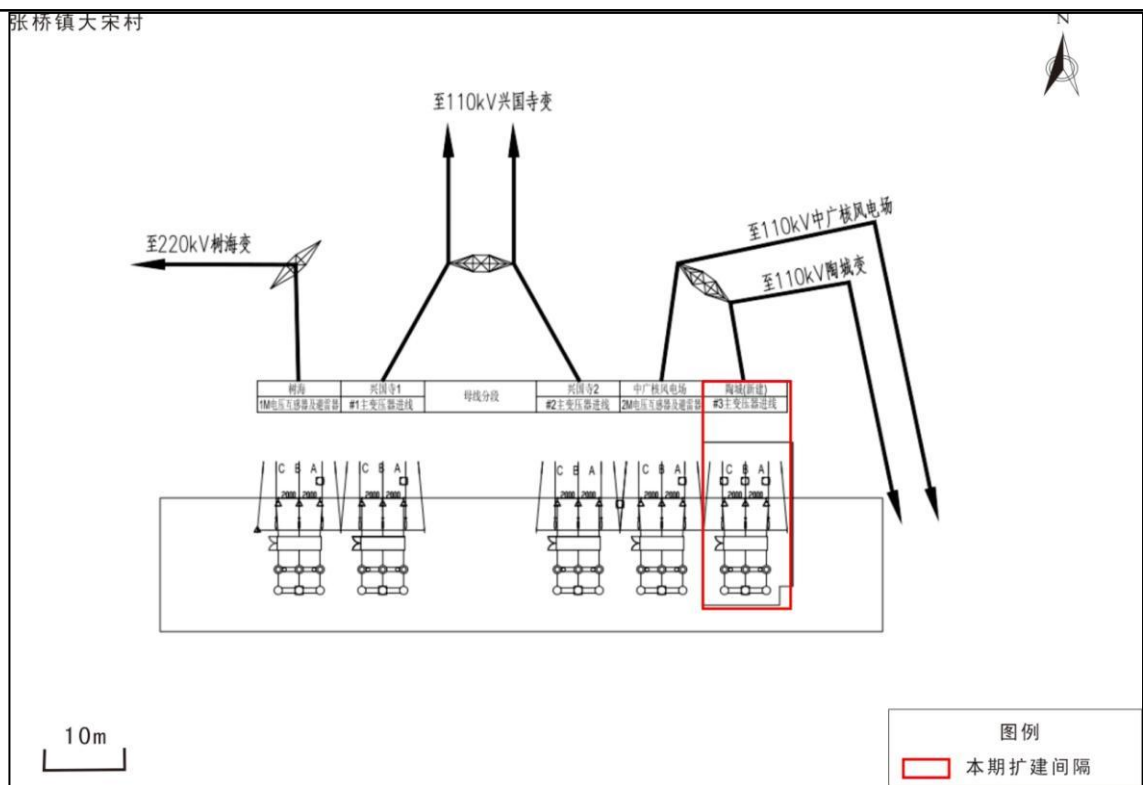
张桥 110kV 变电站本期扩建间隔平面布置示意图
